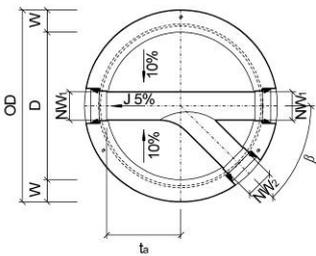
Grundriss CRENO Normschachtboden Typ 5
